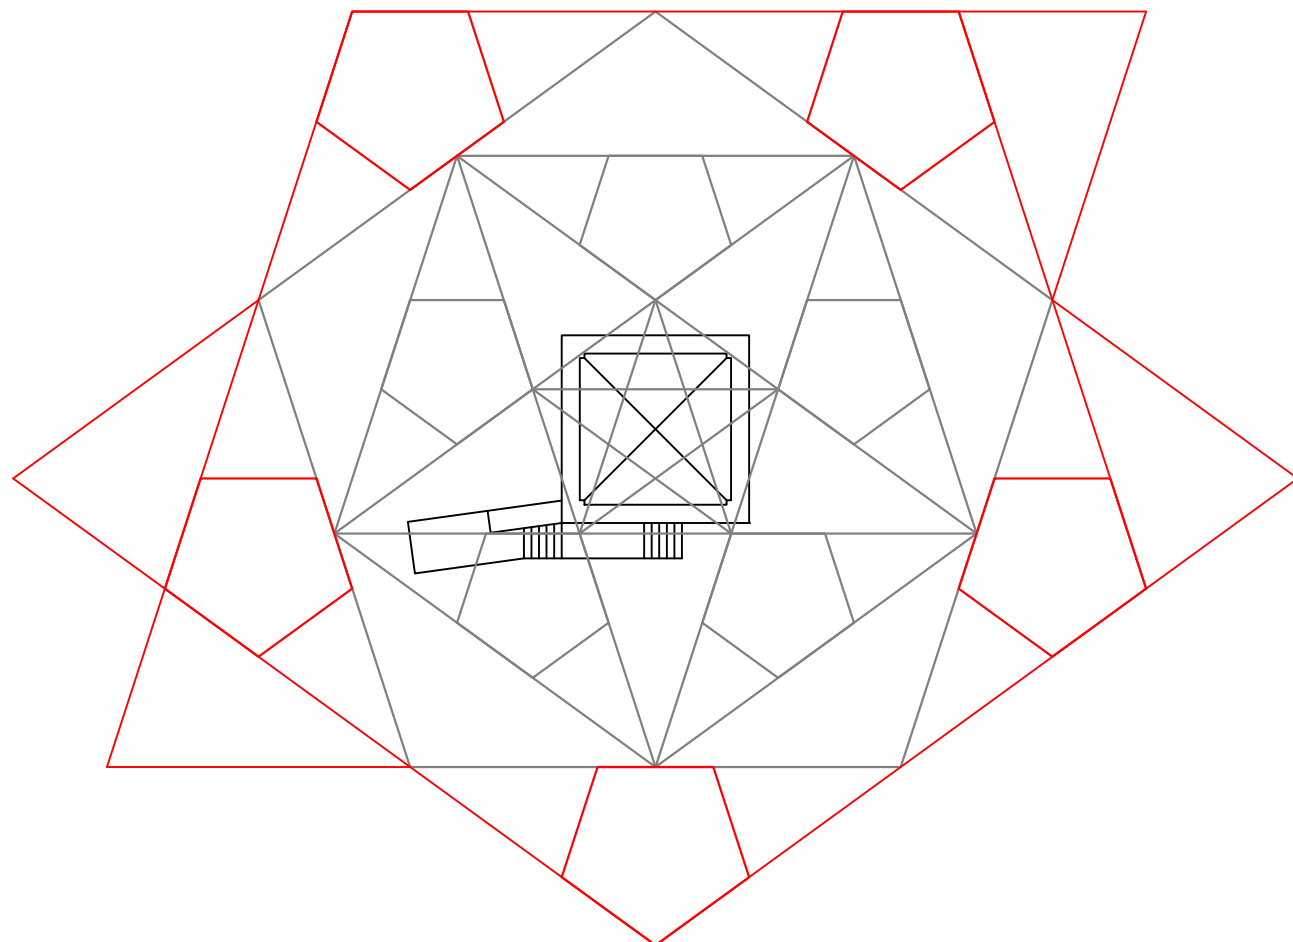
Versuch über das Fünfeck auf einen fraktalen Grundriss zu kommen
